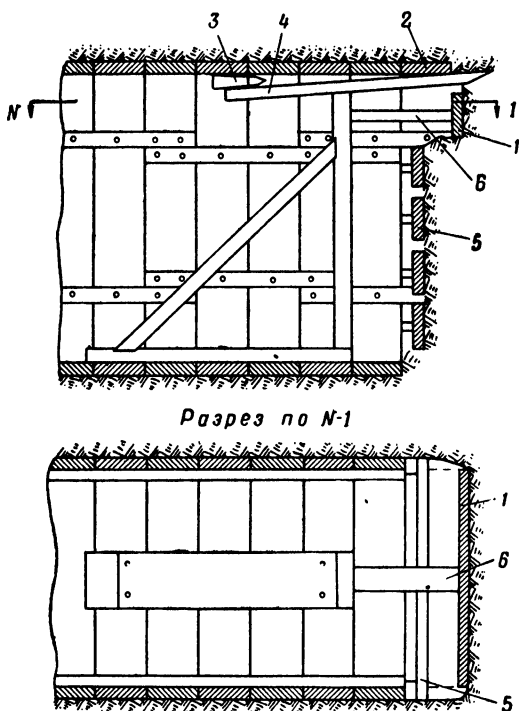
Проходка галерей со вспомогательной стойкой с креплением лба забоя:
